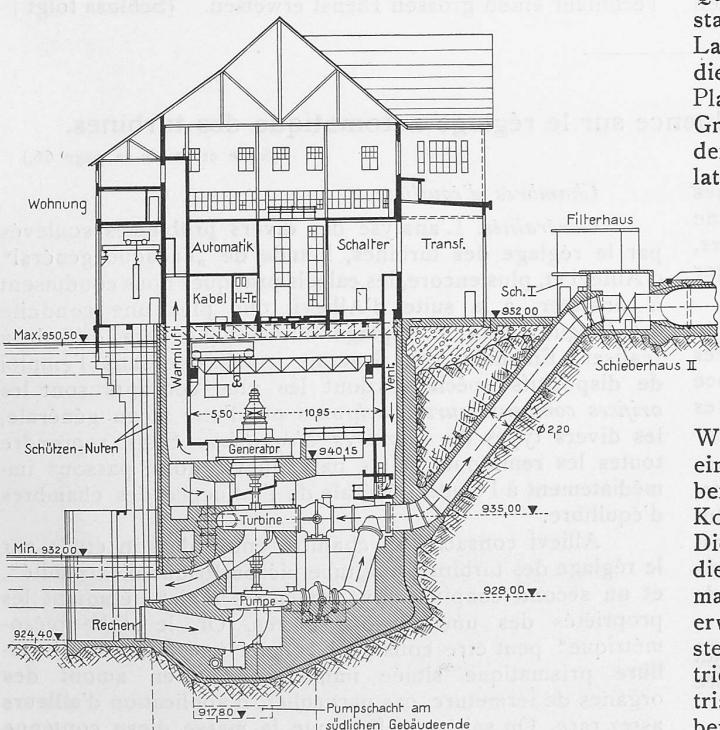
Querschnitt des Maschinenhauses. — Massstab 1:600.
